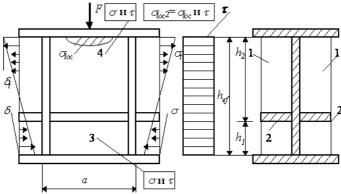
Схема балки, укрепленной поперечными основнымиребрами и продольным ребром жесткости
